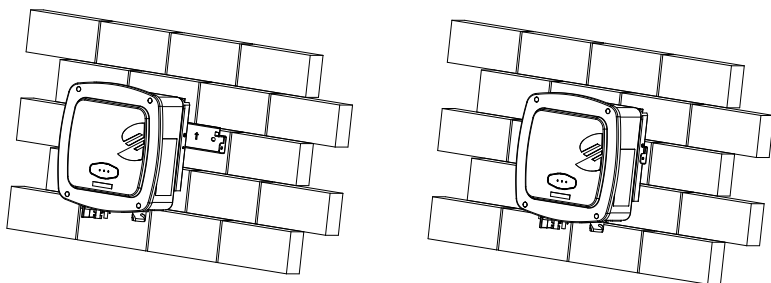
Montaggio dell'inverter SUNWAY™ SI-0.7K-3K-S1 & SUNWAY™ SI-3K-8K-S2
